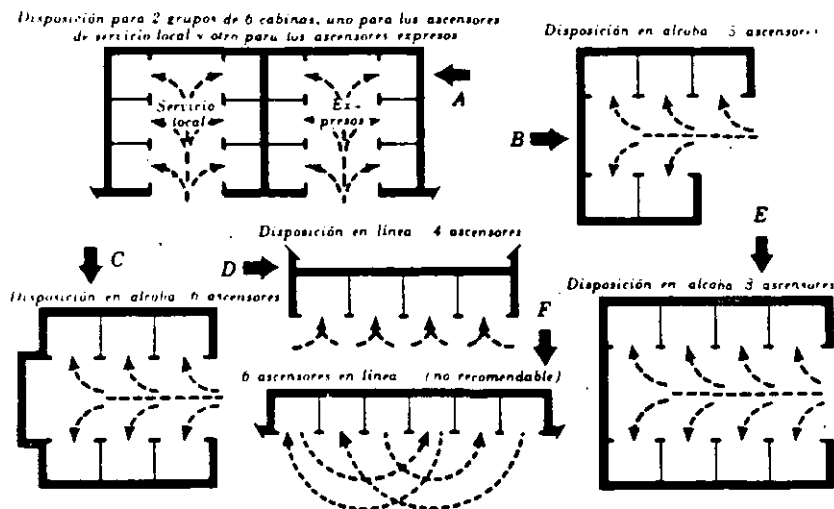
Las disposiciones A, B, C, D y E facilitan la entrada y salida de los ascensores en la planta baja. La disposición F nunca se usa, pues la circulación en sentido transversal dificulta la entrada y salida de los pasajeros.
